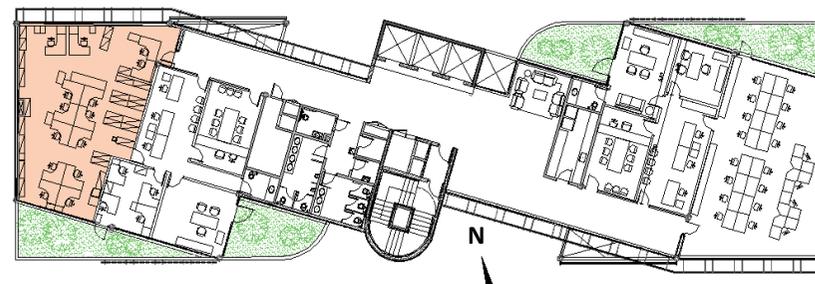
Planta Baixa do 3º Pavimento do TJDF
